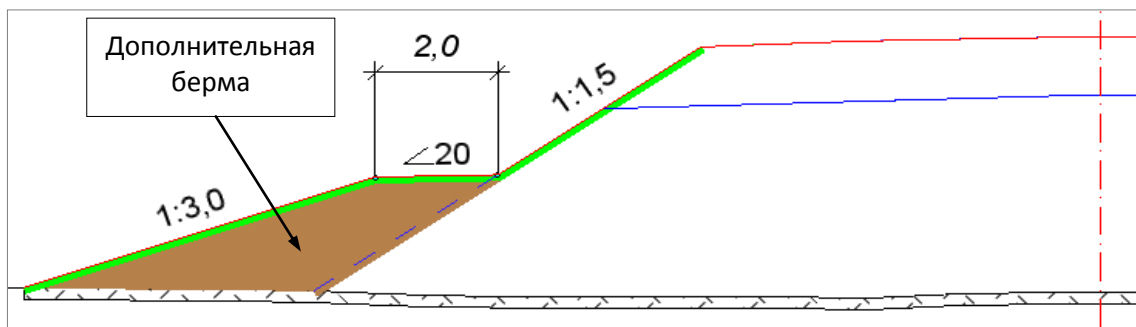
Насыпь с дополнительной бермой на расчетной высоте
